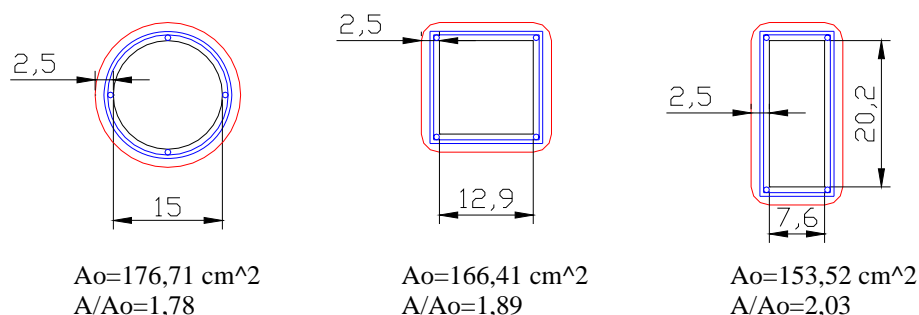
Seção transversal dos pilares após o encamisamento com concreto armado.
